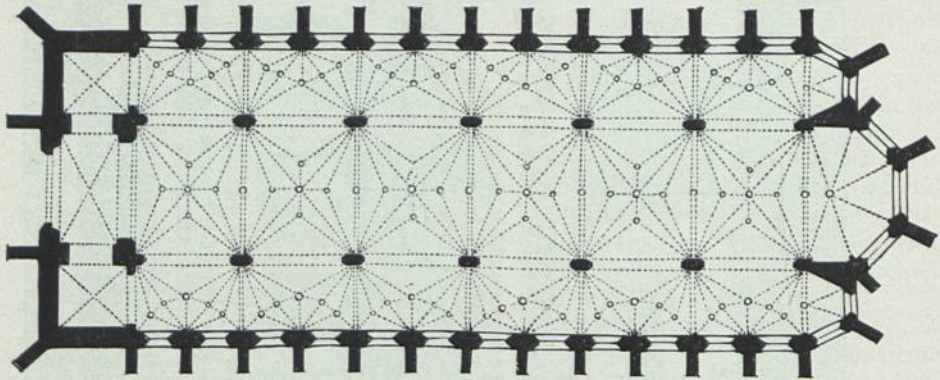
Grundriss der Sandkirche zu Breslau
